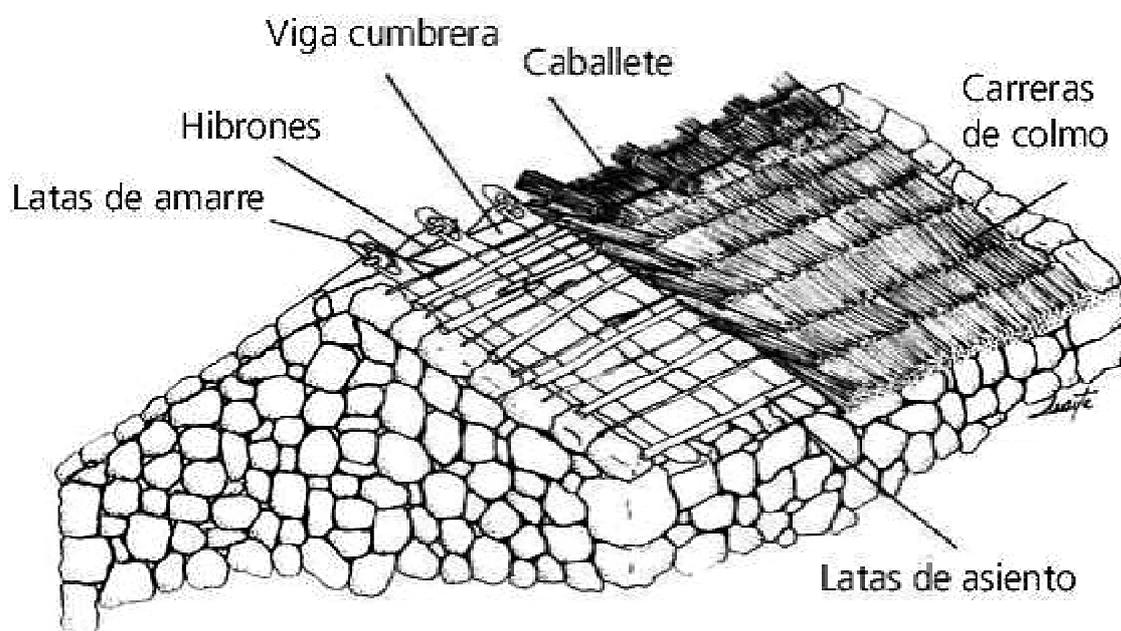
Esquema de entramado de la cubierta pajiza (Sánchez Perera y Casañas Barrera 2008)
